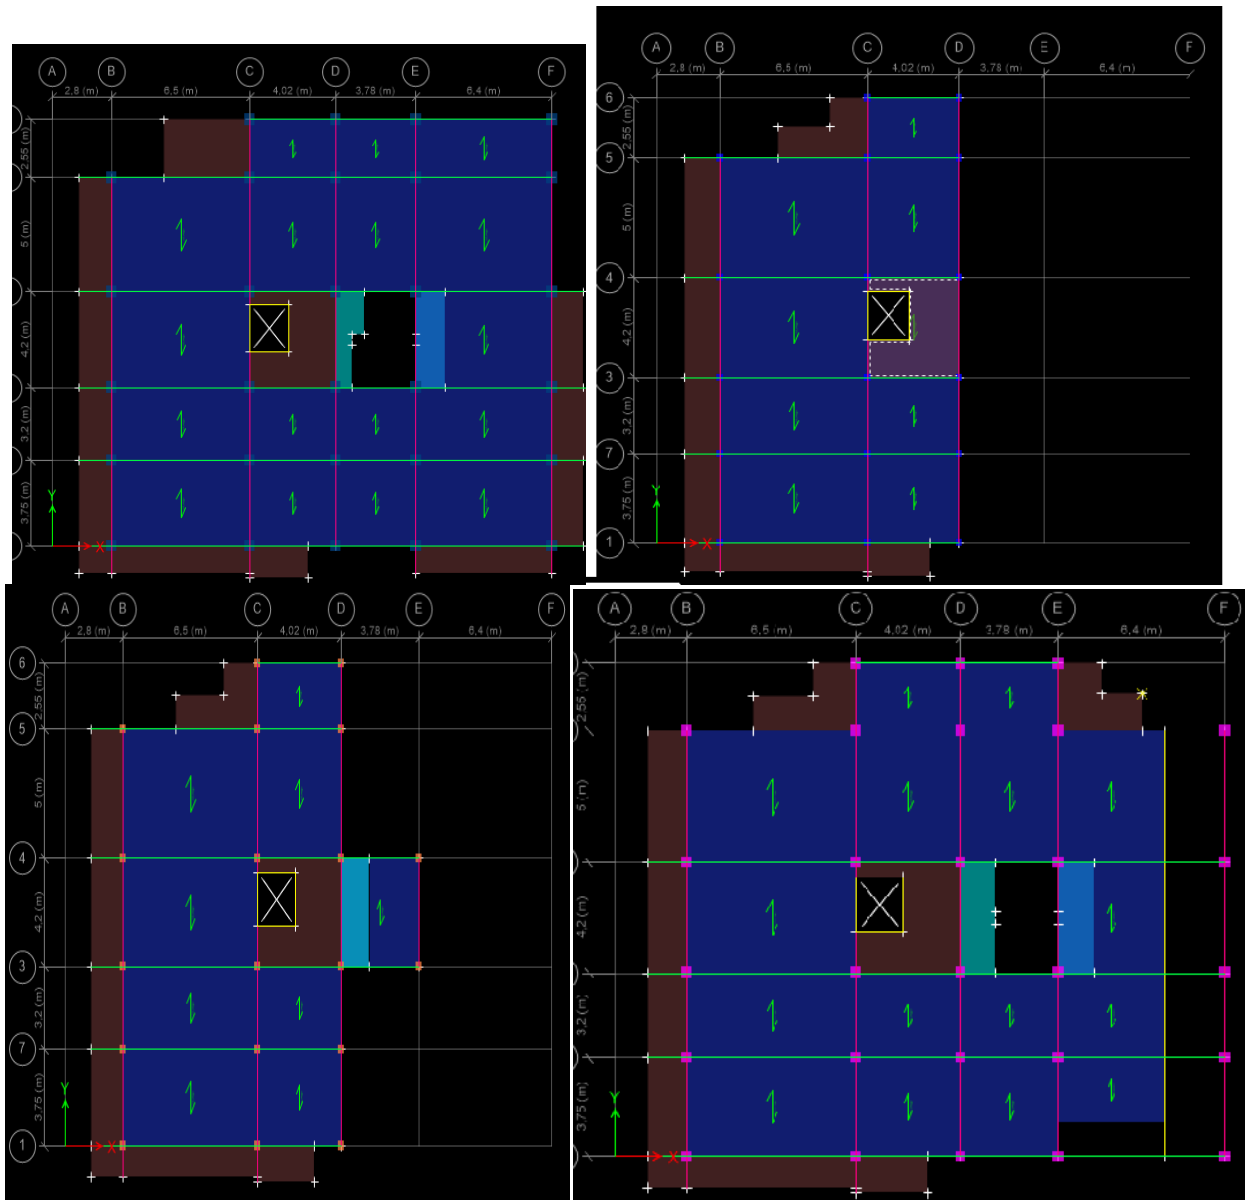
Disposition des poutrelles dans les différents niveaux. :
